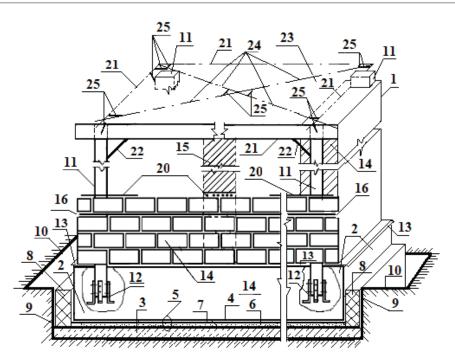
Устройство сейсмостойкого малоэтажного здания из местных материалов: 1—сейсмостойкое одноэтажное здание; 2—монолитный бетонный фундамент; 3—бетонная подготовка; 4—подошва фундамента; 5— скользящий слой; 6—сухой крупнозернистый песок; 7—2—3 слоя полиэтилена; 8—демпфер из полистирольных или камышитовых плит; 9—выемка под фундамент; 10—уровень земли; 11—каркас; 12—металлические накладки; 13—гидроизоляция; 14, 15—саманные блоки ограждающих и поперечных стен; 16—армирующая плетенная сетка; 17—полимерные шнуры; 18—распущенные камыши; 19—скрутки; 20—распущенный или целый камышовый стебель; 21—обвязка; 22—раскосы; 23—перекрытие; 24—диагональные раскосы; 25—металлические скобы
